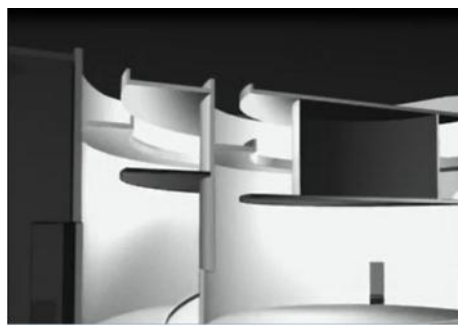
Coupe sur le dispositif d'éclairage zénithal
